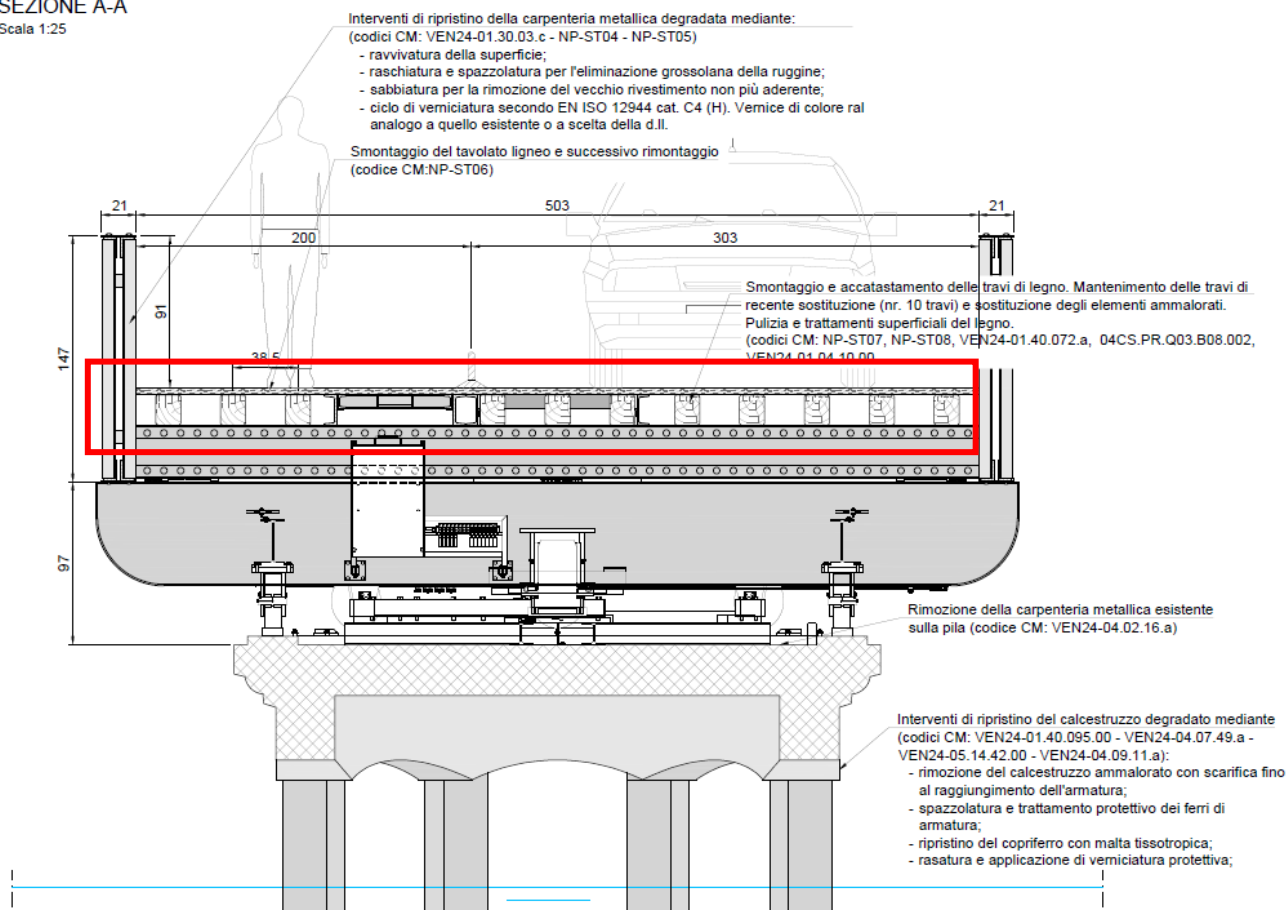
Sezione trasversale con indicazione delle travi lignee,
